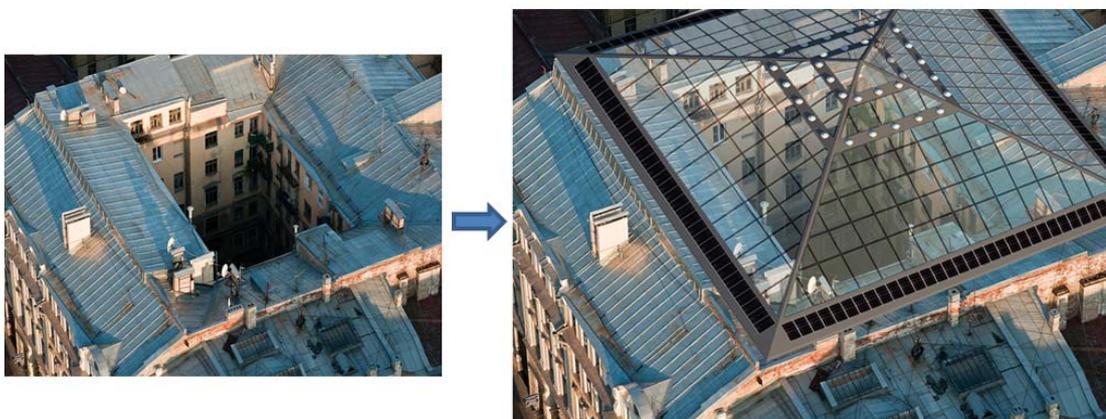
Модель конструкции покрытия двора-колодца с передачей нагрузки на флигели здания с наружным водостоком
